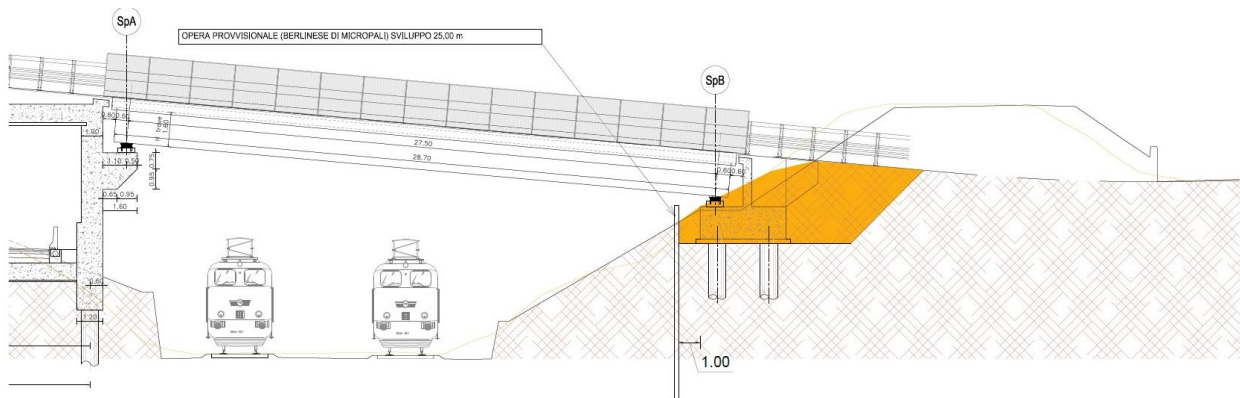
Sezione longitudinale Cavalcavia CV01
